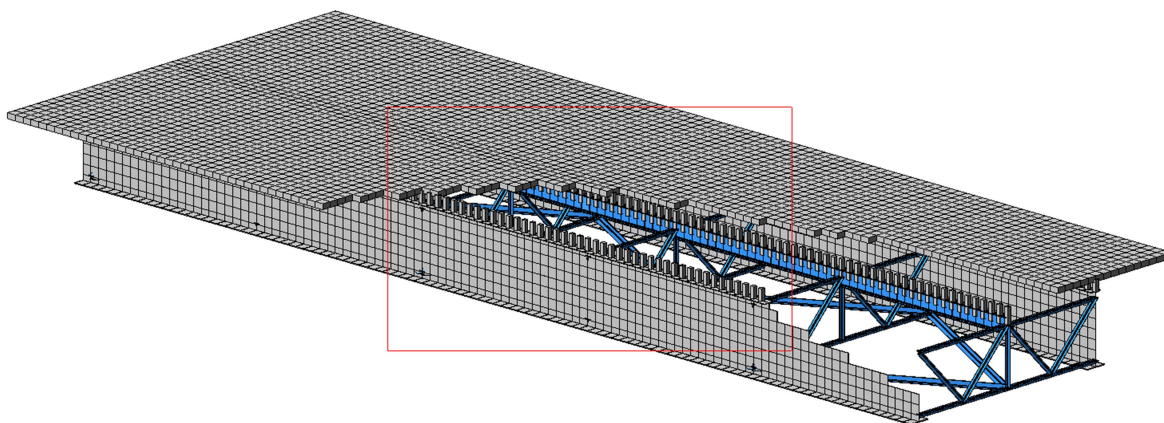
Расчетная схема МКЭ сталежелезобетонного пролётного строения
